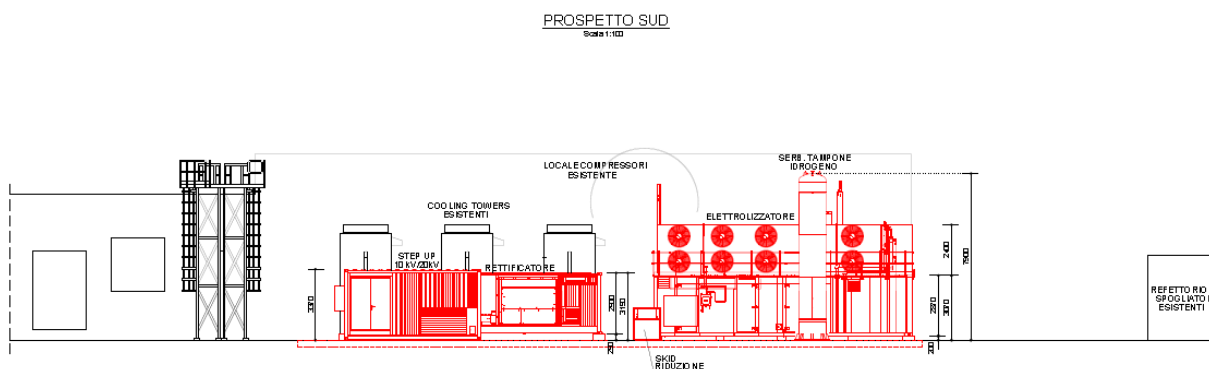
Layout di progetto – Prospetto Sud Zona 1 di intervento
